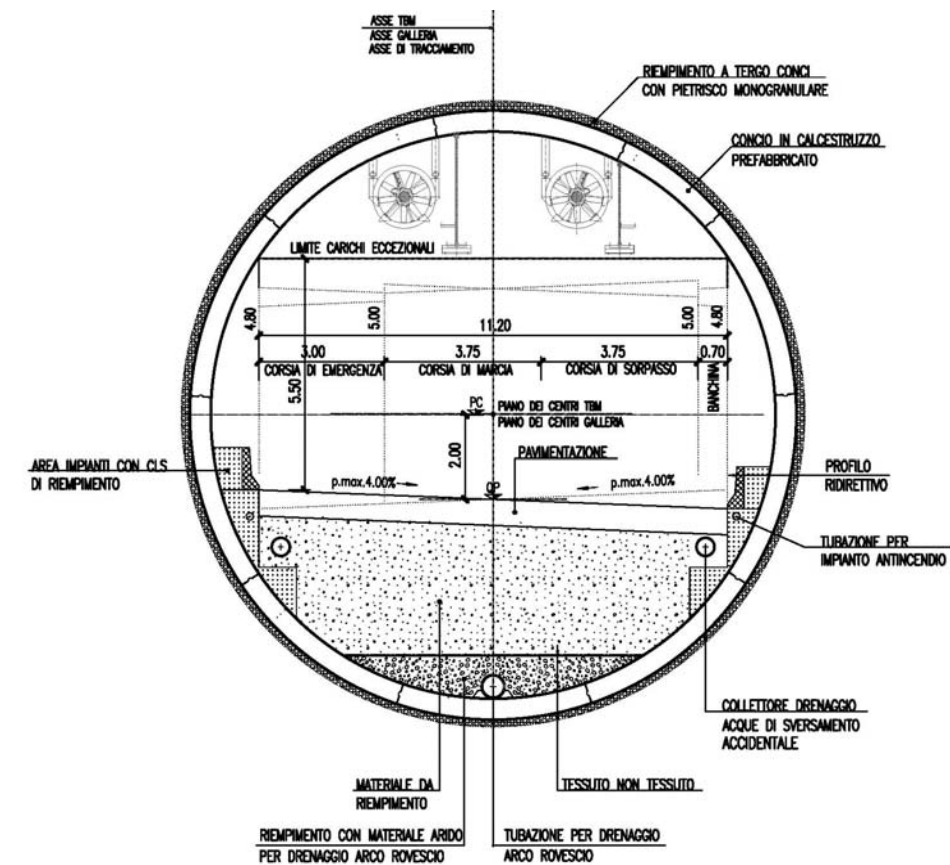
Sezione tipo in galleria naturale con scavo meccanizzato
